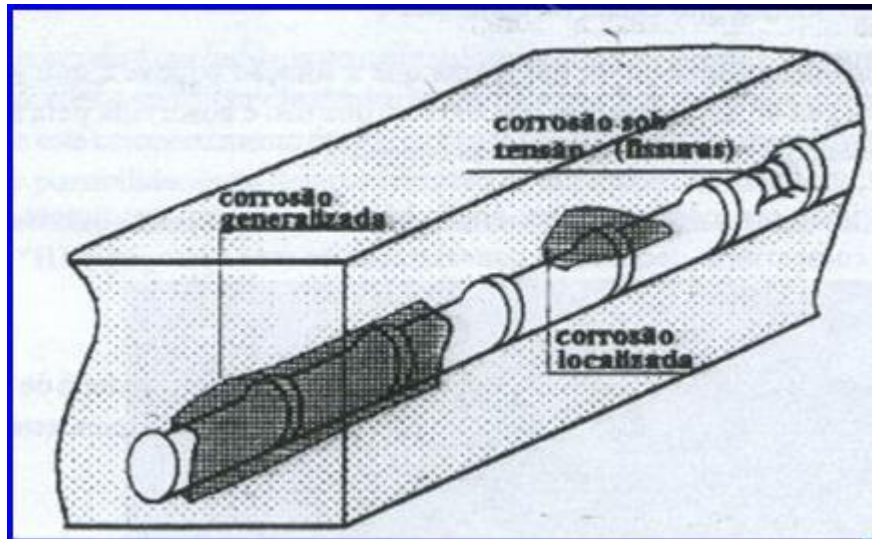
Tipos de corrosão em barra de aço imersa em meio concreto (HORMIGONELABORADO.COM)
